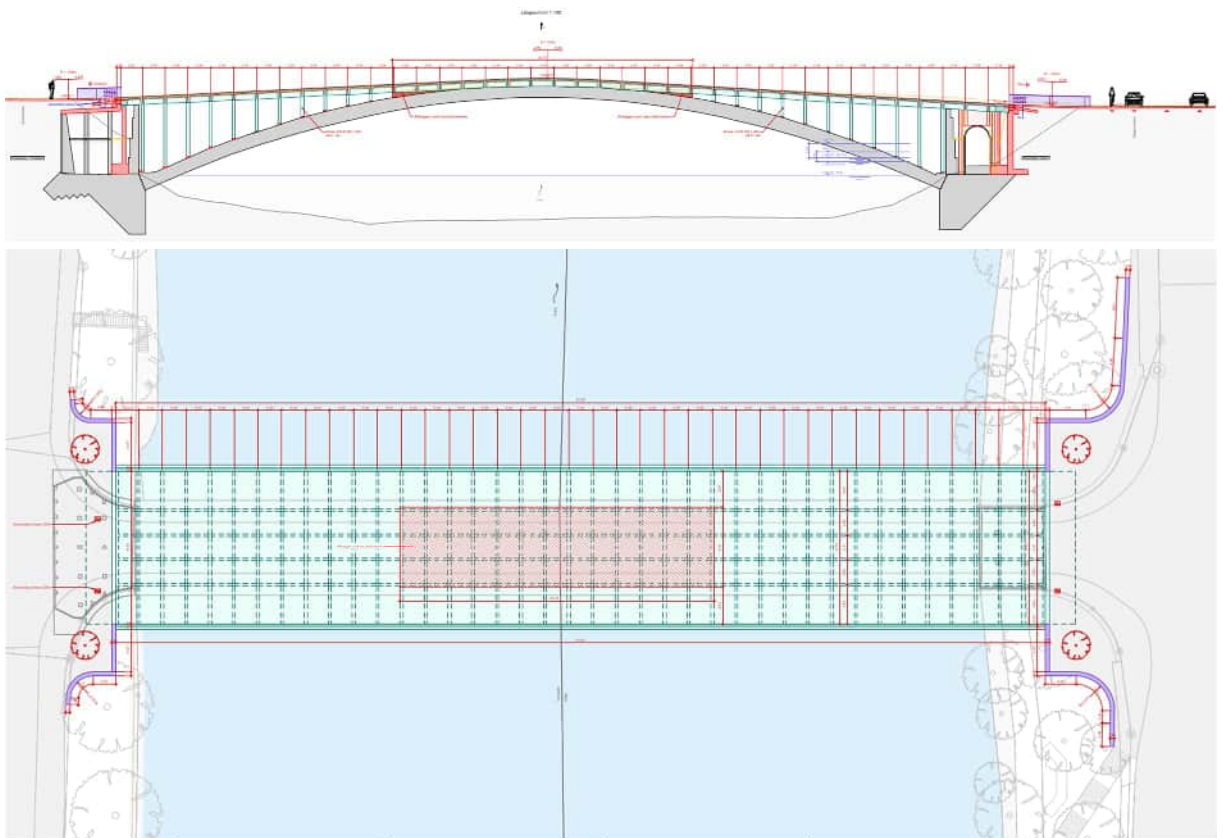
Ansicht Süd (oben) und Grundriss (unten) der Trimbacherbrücke.
